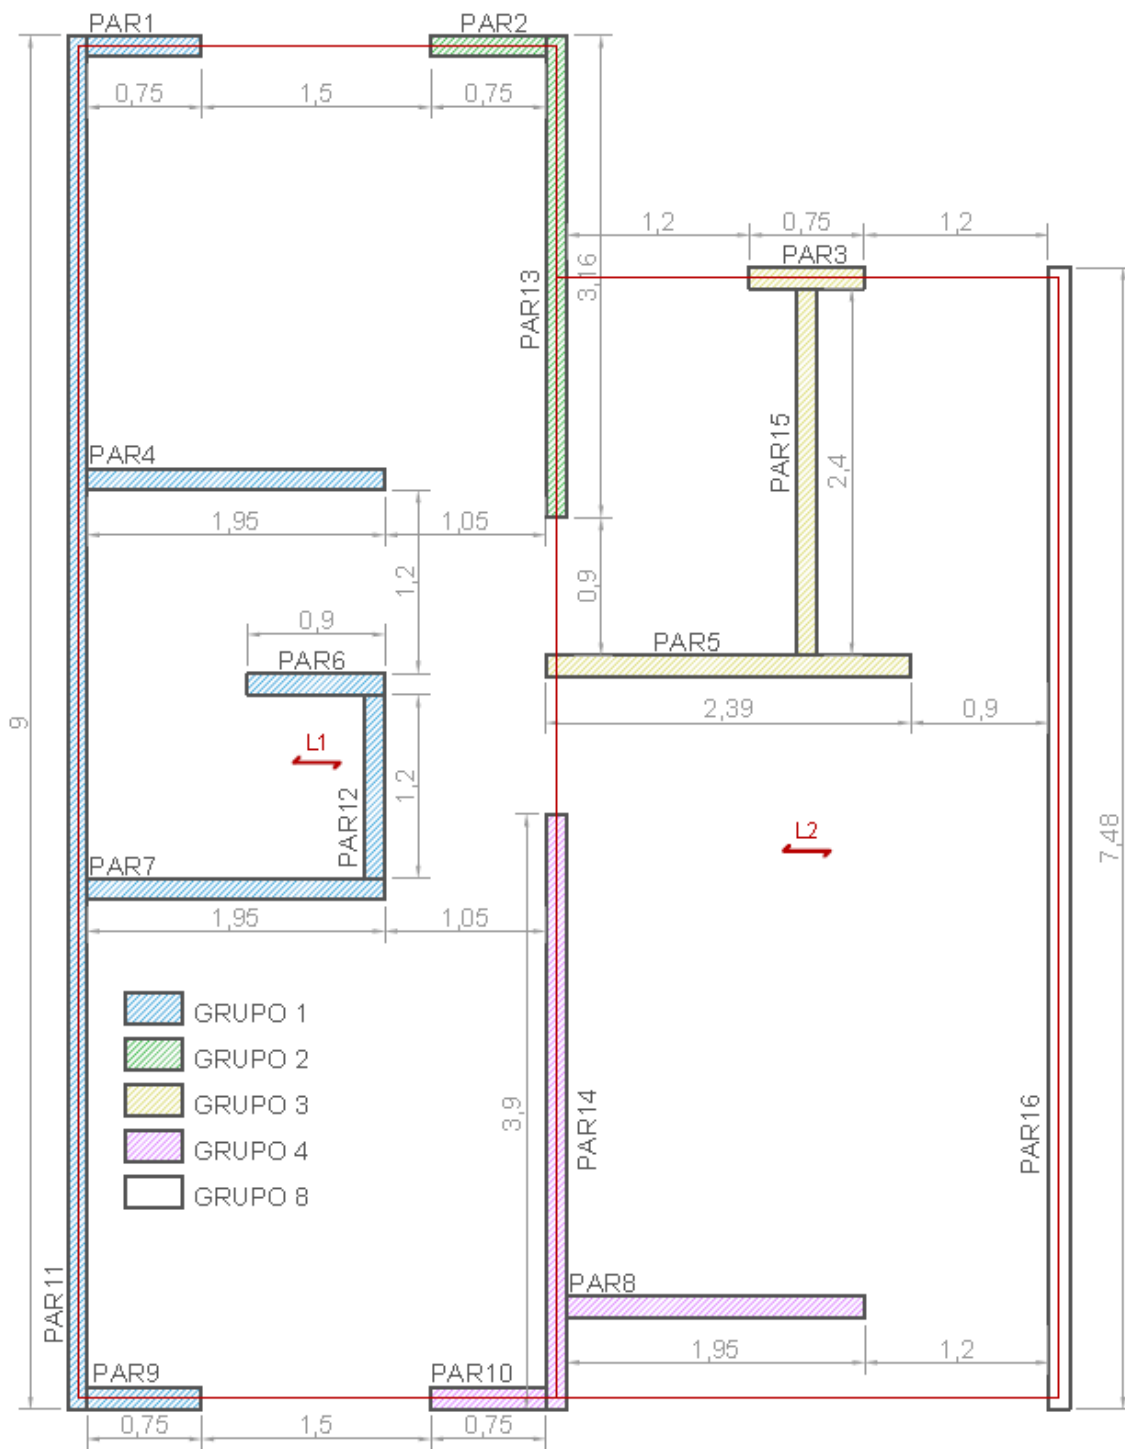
3 Pavimento superior: definição dos elementos estruturais.
